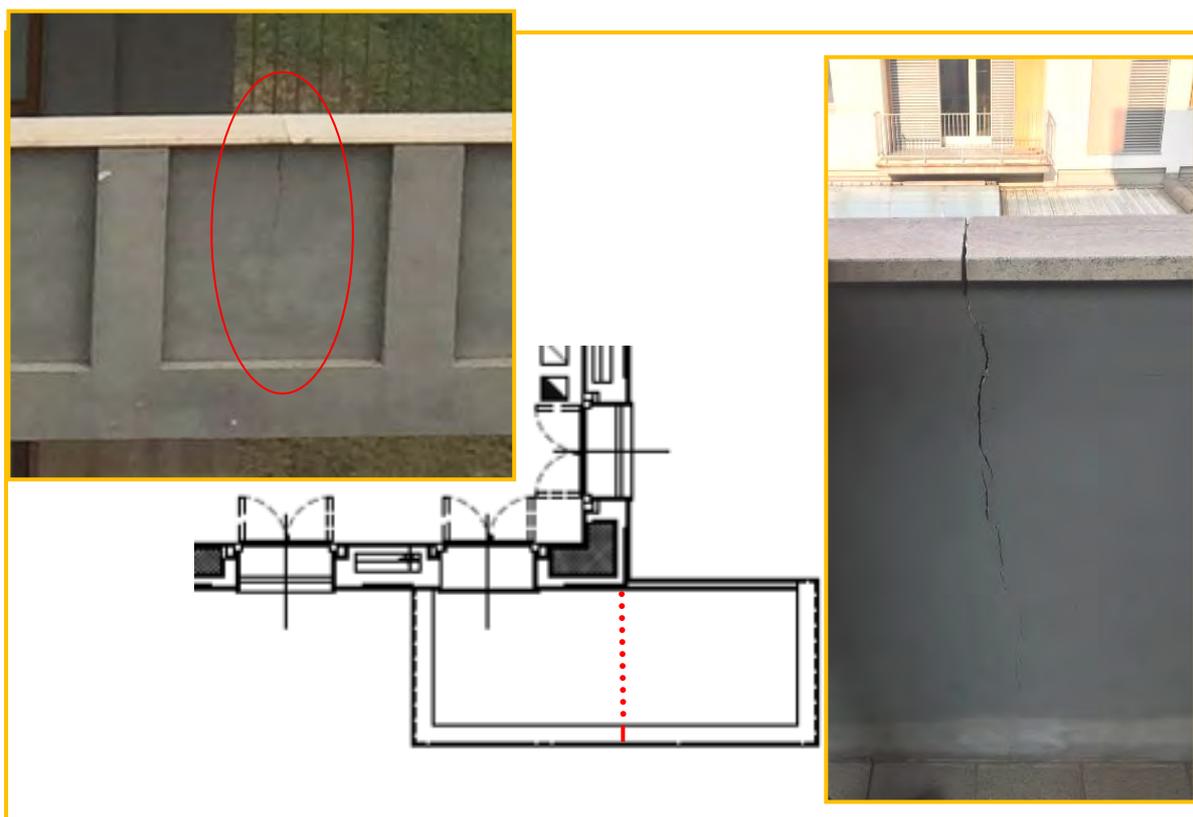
Palazzina B2 – in evidenza la fessura in prossimità dello sbalzo (lato esterno del parapetto a sx e lato interno del parapetto a dx)
